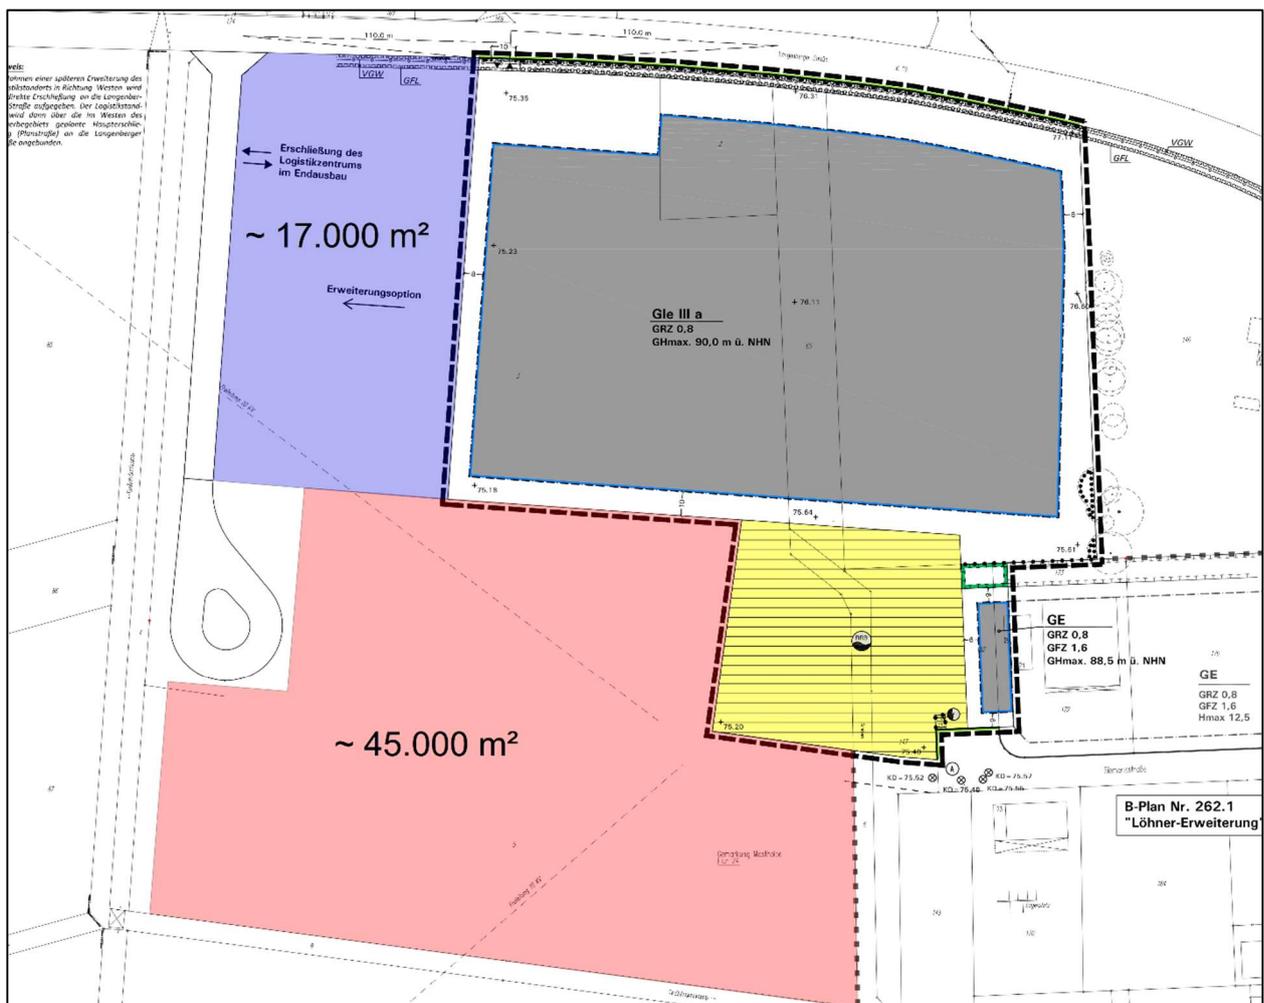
Lageplan Erweiterung Gewerbegebiet [Quelle: Stadt Rietberg]
